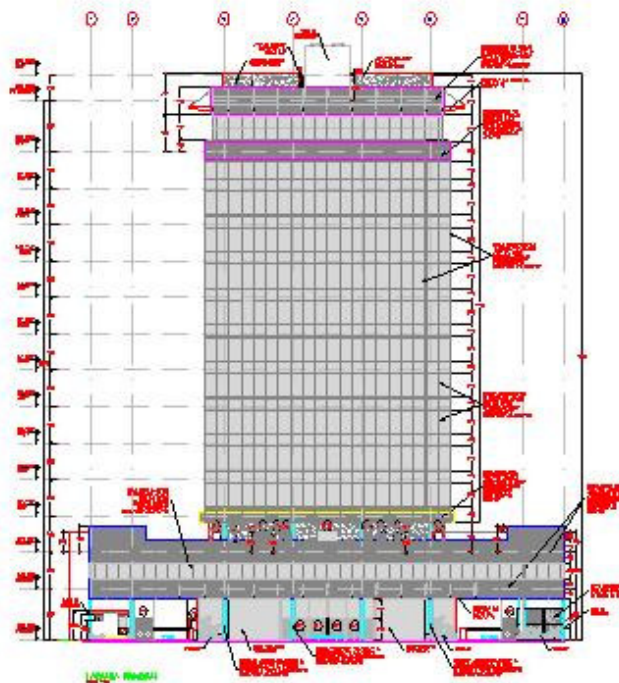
Fachada principal (Fuente: Ossenbach, Pendones & Bonilla S.A.)
